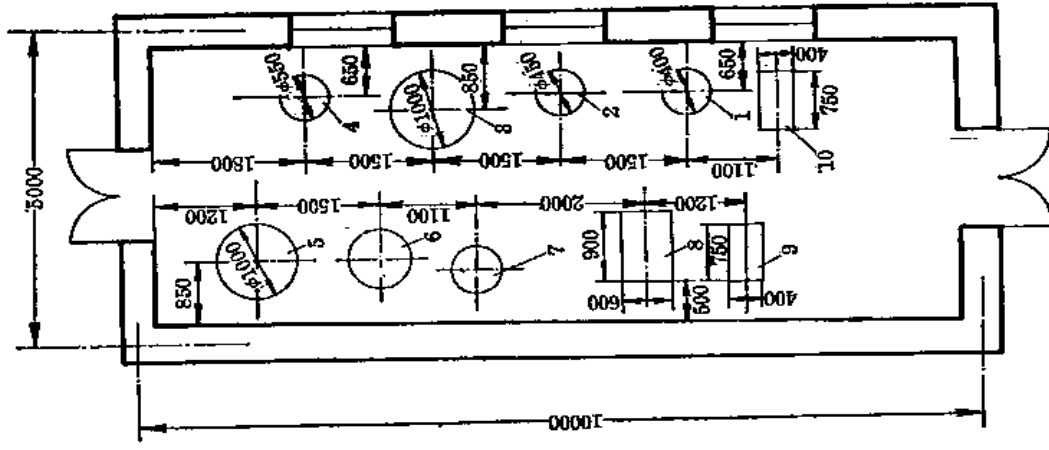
涡流反应器石灰水处理系统设备布置平面图
